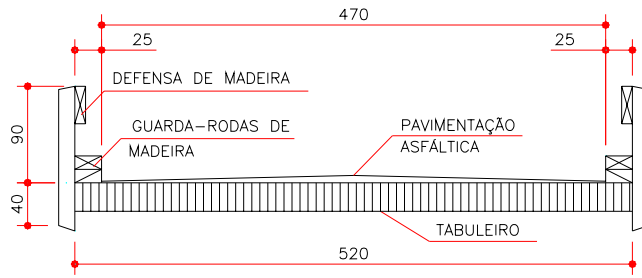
Seção transversal da ponte em placa protendida transversalmente com uma faixa de tráfego
